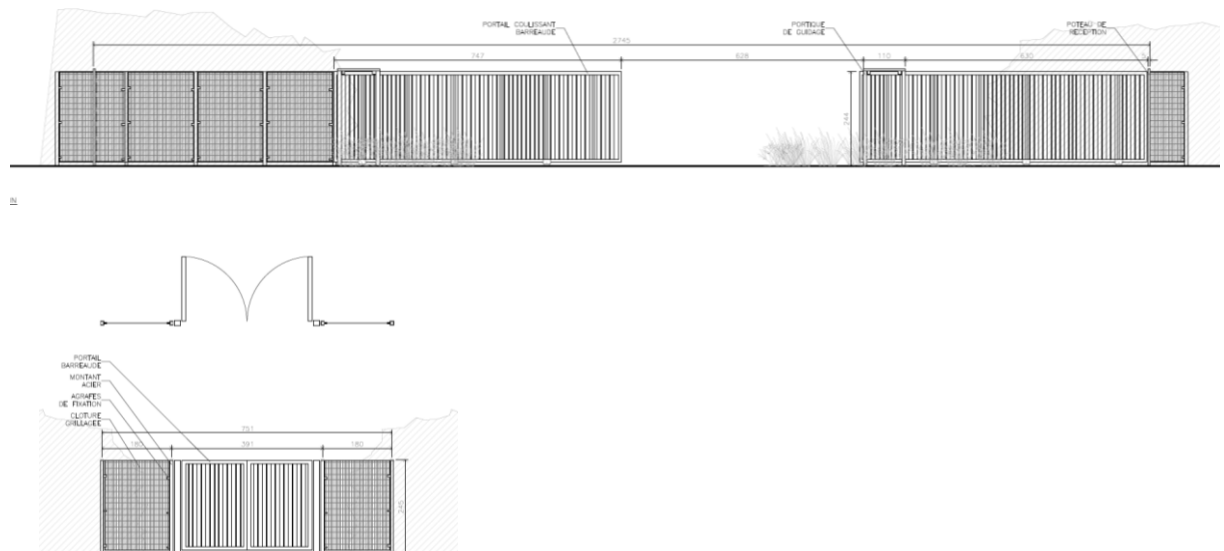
Extrait plan et élévations portails et clôtures projet (Cf. PA4n.1)
